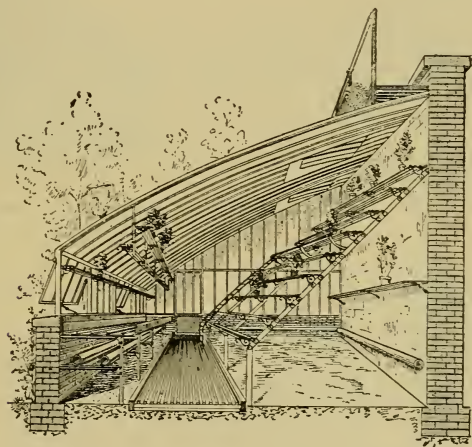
Serre adossée, (coupe transversale) comble convexe et pied droit, panneaux d'aération ; gradins et tablettes pour l'installation des plantes.
